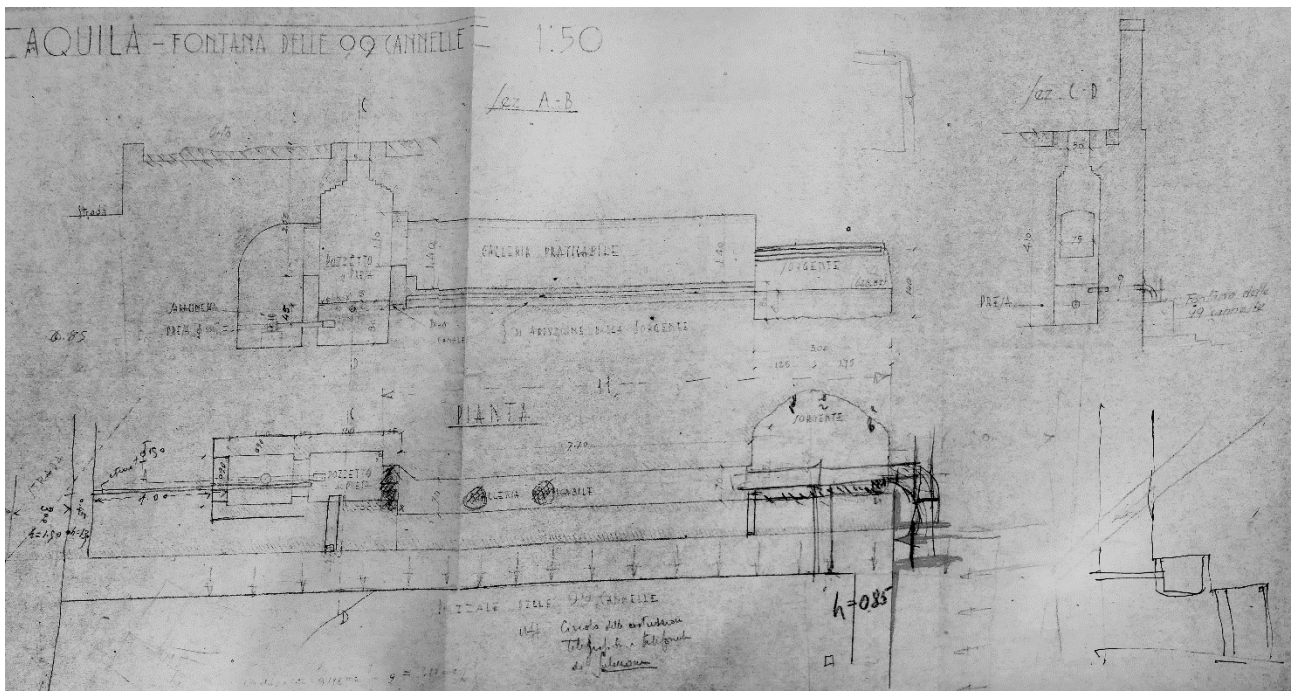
Pianta e sezioni delle gallerie dietro il prospetto Nord della Fonte della Rivera. In particolare sulla sinistra, al di sotto del pozzetto è possibile individuare la sorgente “S3” con la derivazione per la stazione ferroviaria e sulla destra la sorgente “S2”; manca del tutto l’altro ramo della galleria, parallelo al prospetto Est, connesso idraulicamente alla sorgente “S1” proprio tramite la vasca di raccolta della sorgente “S2”. (ASA, Comune dell’Aquila, cat.X, classe 4, busta 78, f.2)
